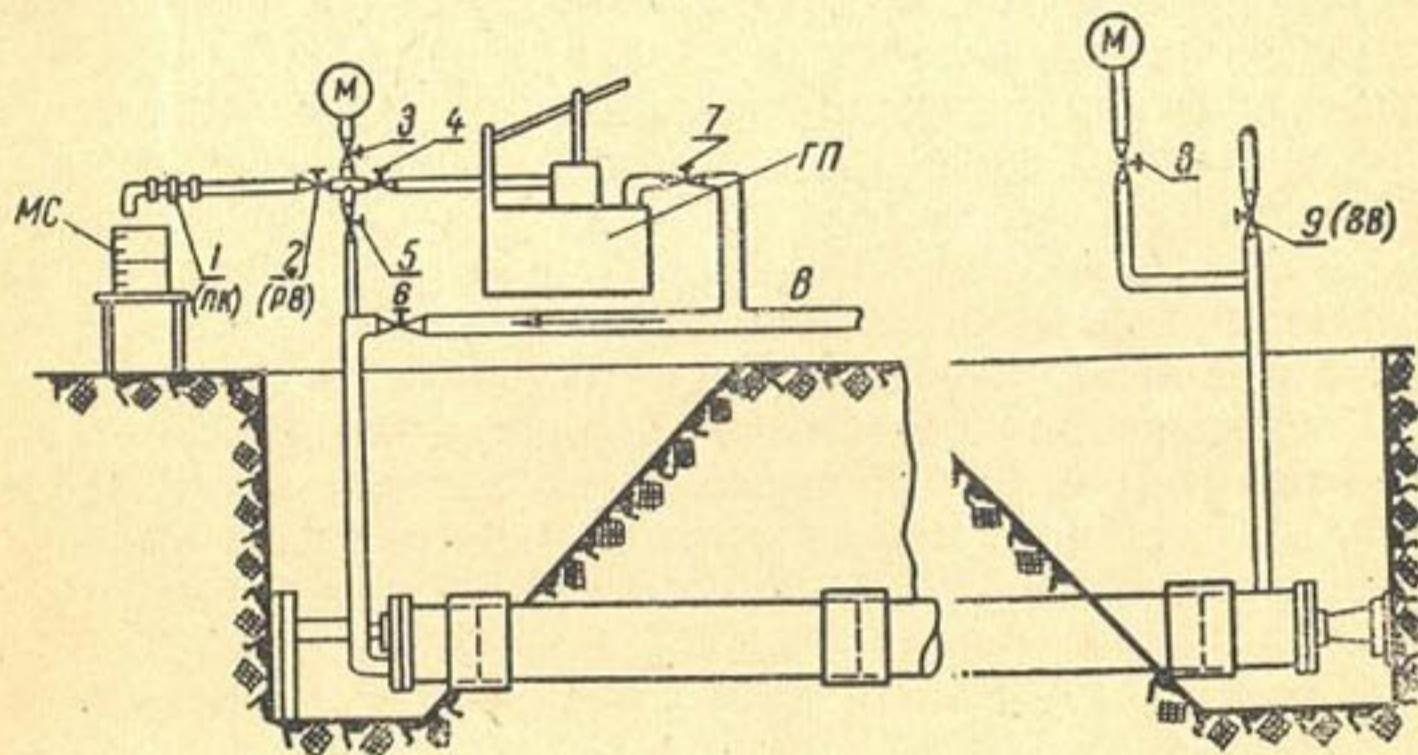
Схема опрессовочного узла при гидравлическом испытании трубопроводов:
